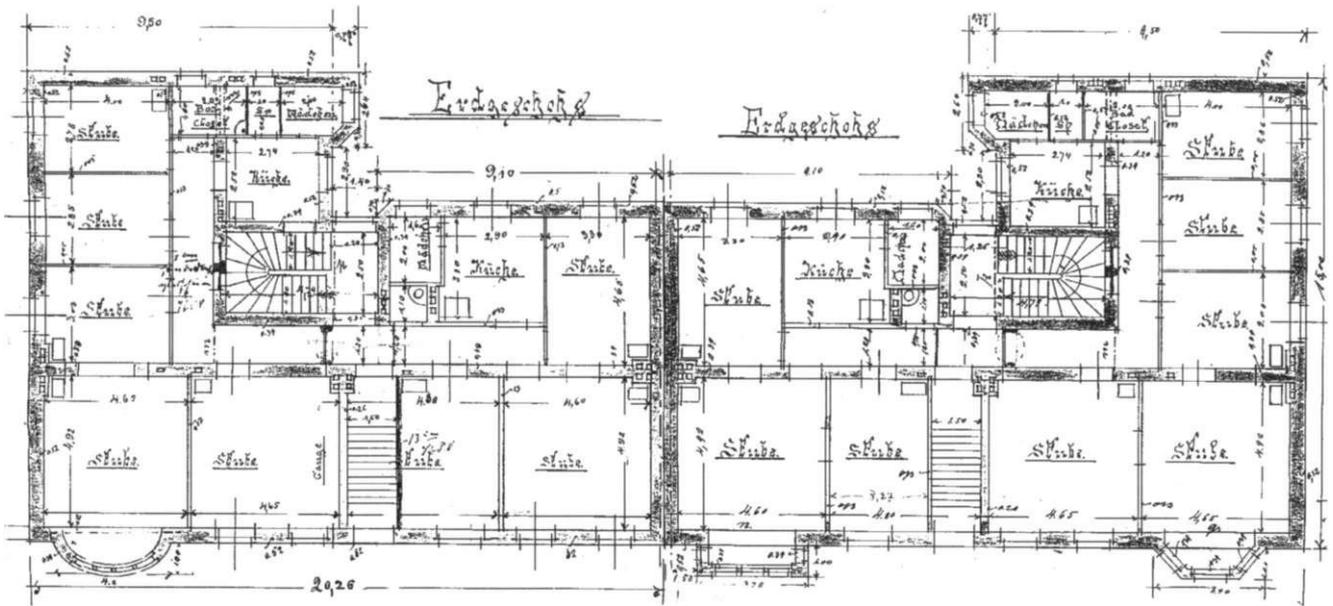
Grundrisse Gerhart-Hauptmann-Straße 62 und 64, Erdgeschoß
